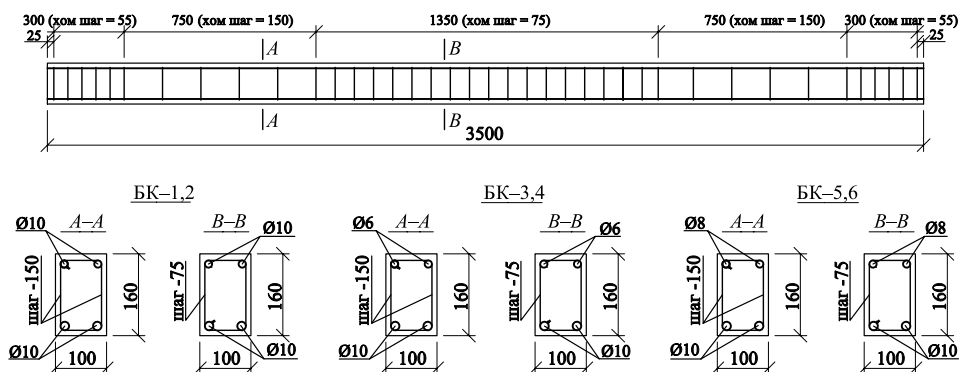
Геометрические размеры и характер армирования бетонных балок
